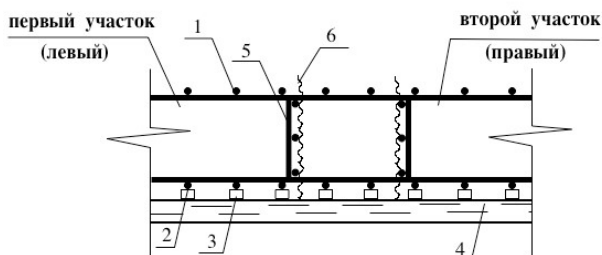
Установка плоских арматурных каркасов и металлической сетки на участках: 1 – верхняя арматура, 2 – нижняя арматура, 3 – фиксаторы защитного слоя, 4 – опалубка; 5 – плоский поддерживающий каркас, 6 – металлическая сетка
